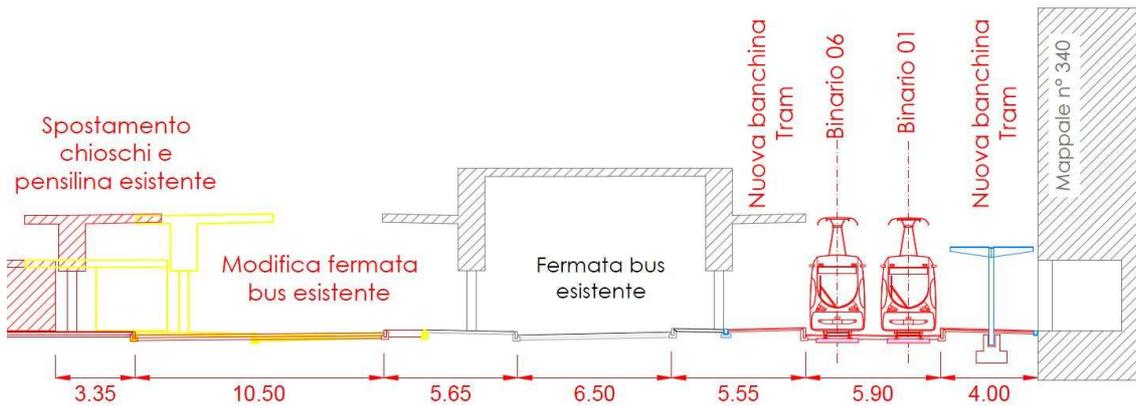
Sezione tipo degli interventi previsti al terminale Lugano centro.
